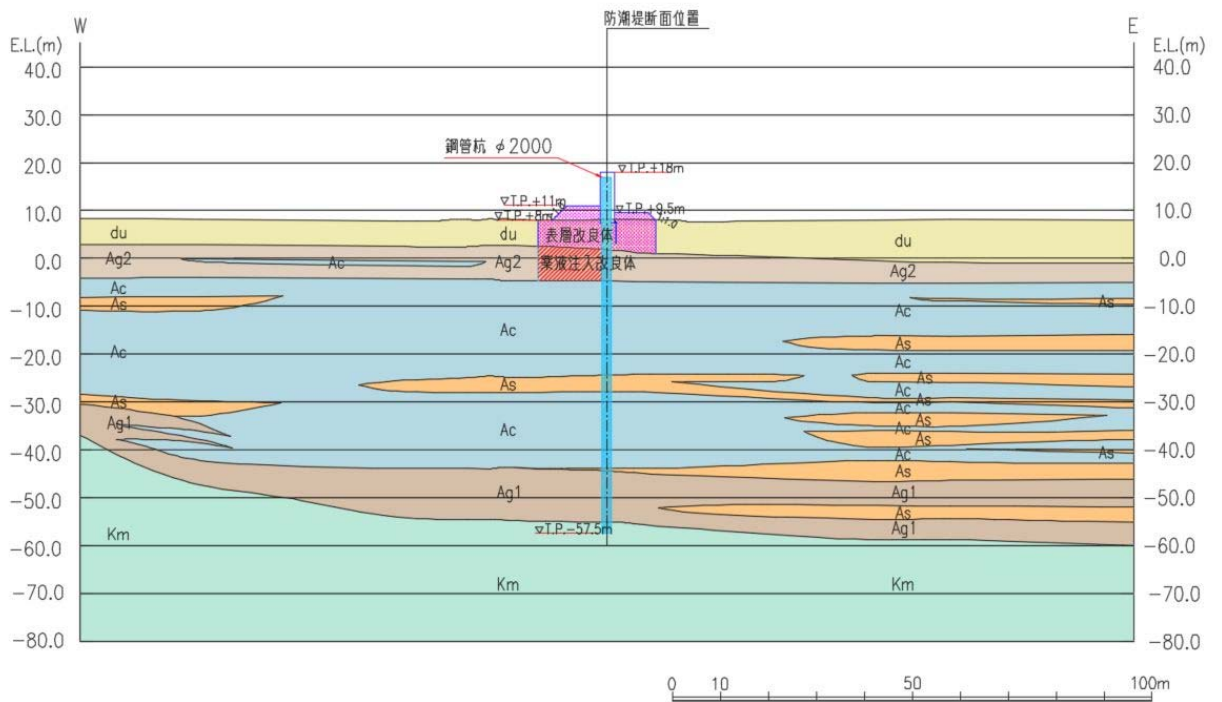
地震応答解析対象断面図 (断面④)
